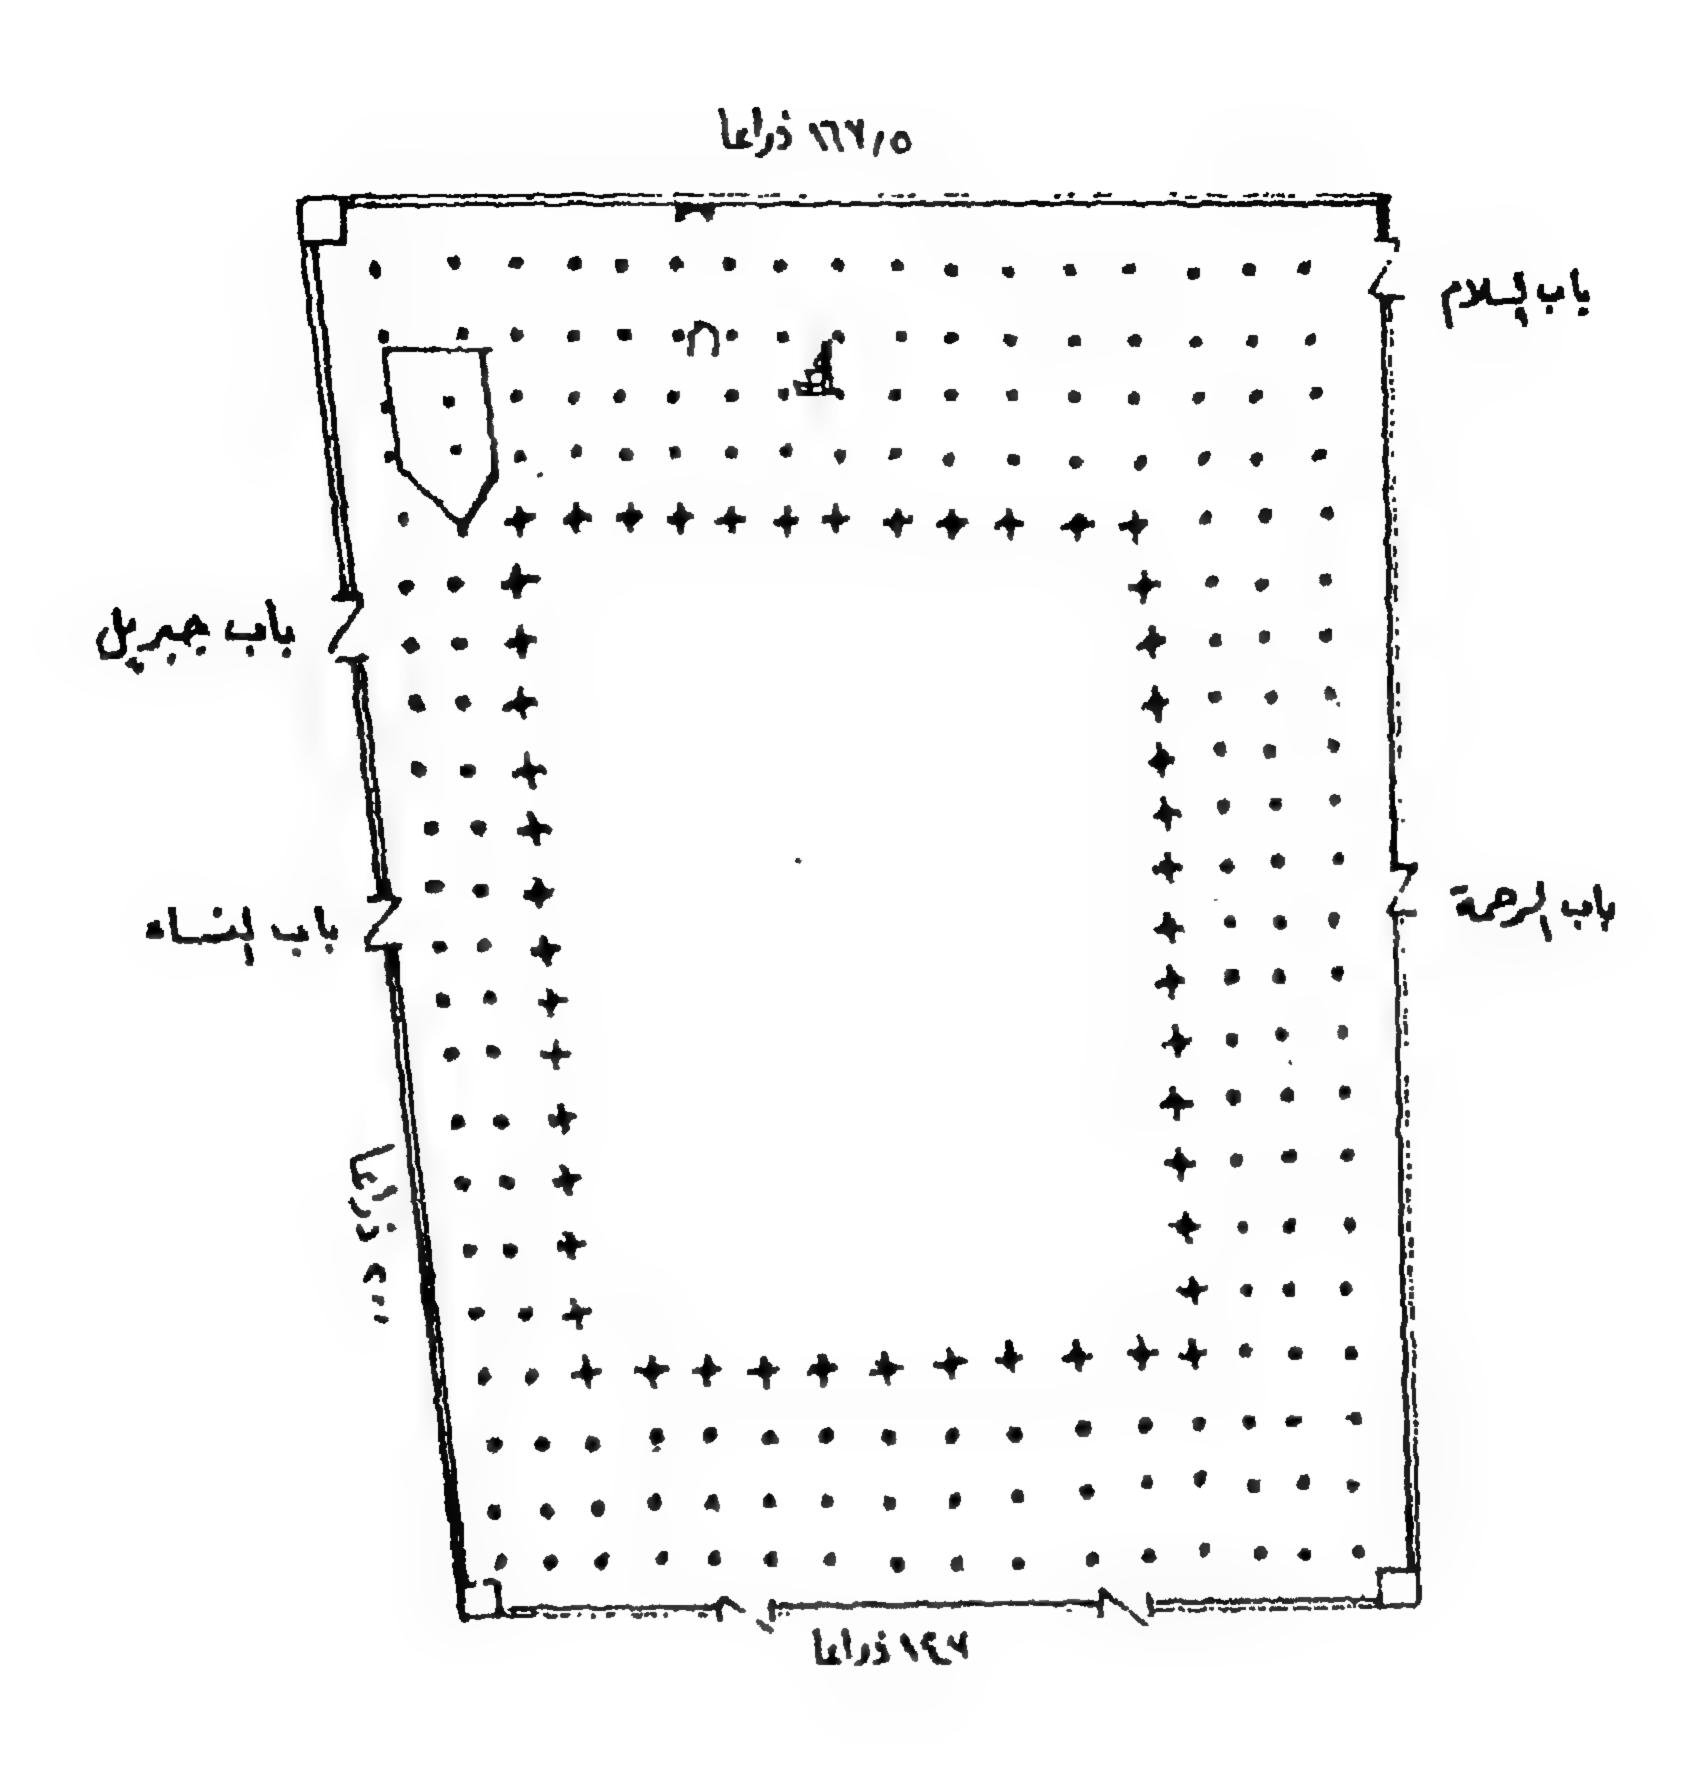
مسقط أفقي للمسجد النبوي الشريف عقب عمارة المهدي العباسي · عن أحمد فكرى ·
